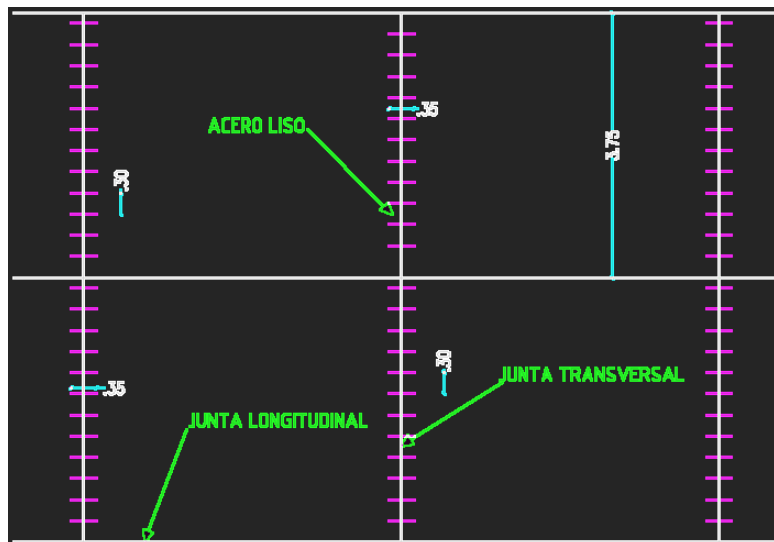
Recomendación para la distribución de las varillas de anclaje
